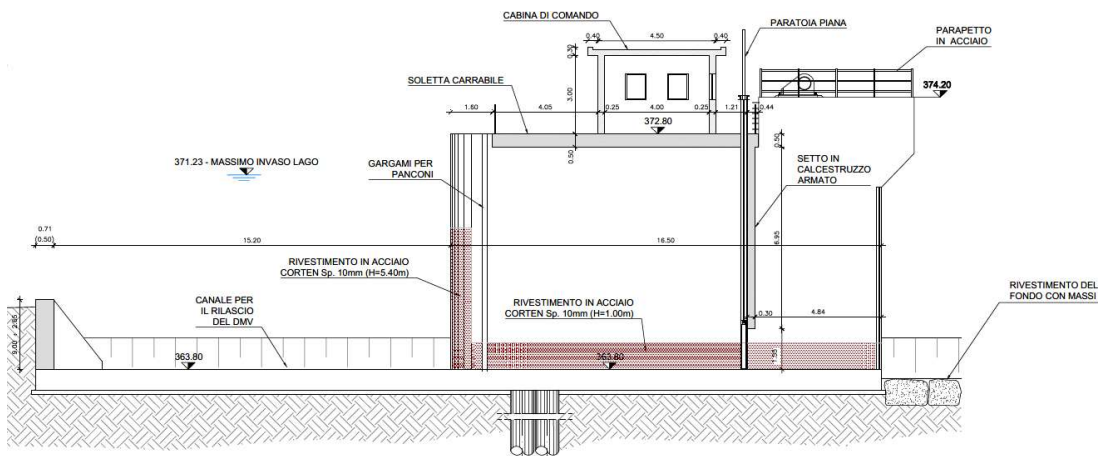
Sezione del canale DMV – Nuova Traversa
